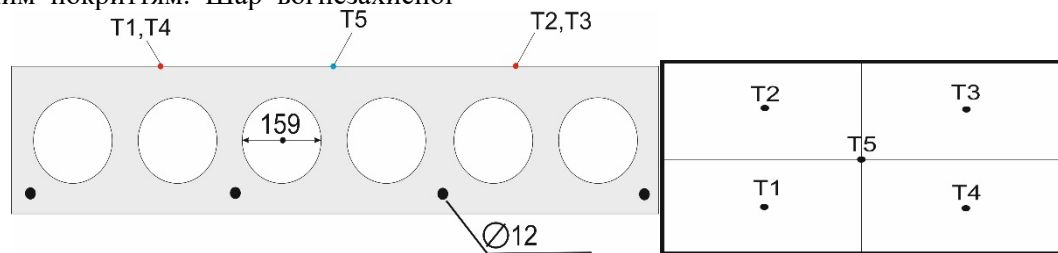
Схема розташування термопар з необігрівної поверхні залізобетонного багатопустотного перекриття при випробуванні на вогнестійкість: а – поперечний переріз, що проходить через термопари T1-T2; б – вид зверху.
